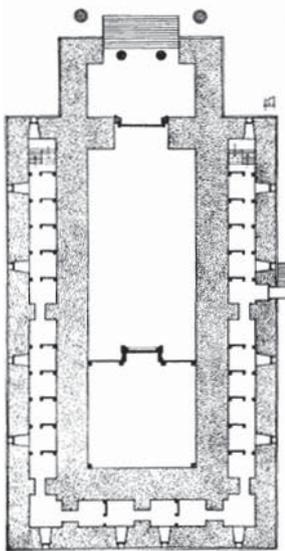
Grundriss der Stiftshütte mit den Angaben der Himmelrichtungen nach dem Alten Testament (Bild rechts oben)
